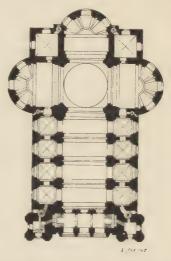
Dom zu Salzburg. Grundriss
